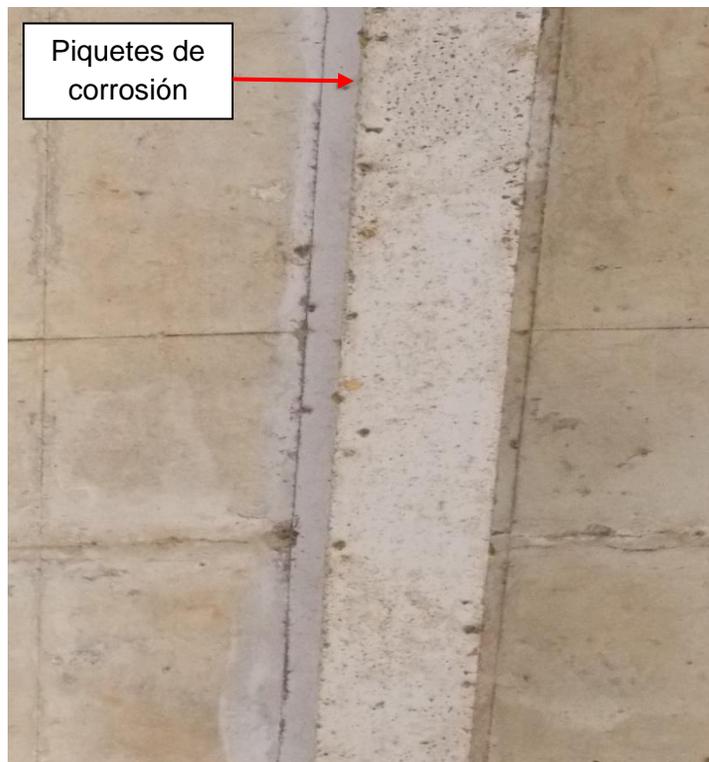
Detalle típico mostrando piquetes de corrosión en las vigas de piso longitudinales.
